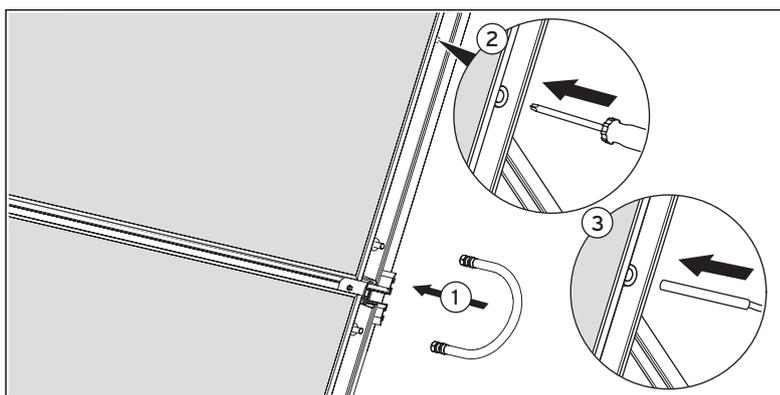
Collegamento reciproco dei collettori drainback VFK 135 D
